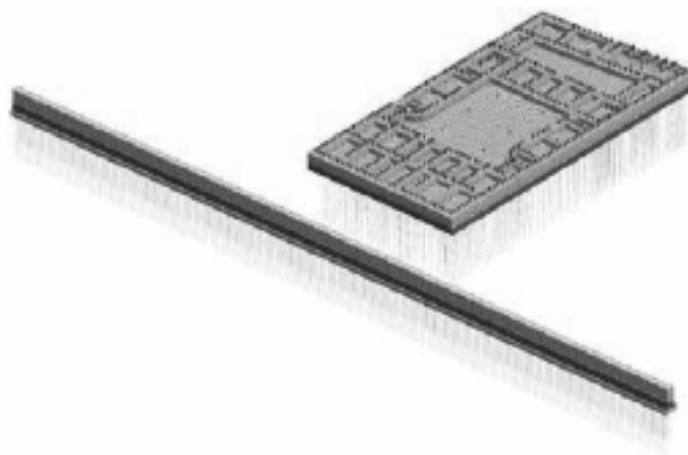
Общий вид расчетной схемы с учетом усиления фундаментов реконструируемого здания сваями БИС. Грунты условно не показаны
